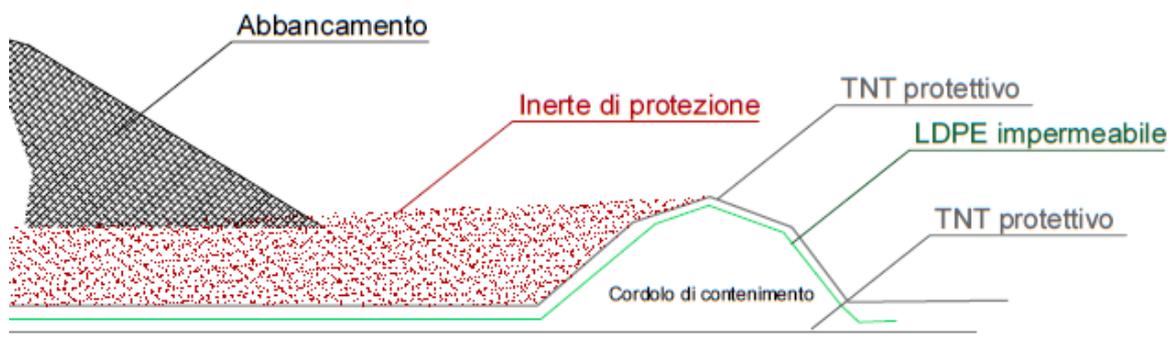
Schema di predisposizione fondo impermeabile delle baie rifiuti
